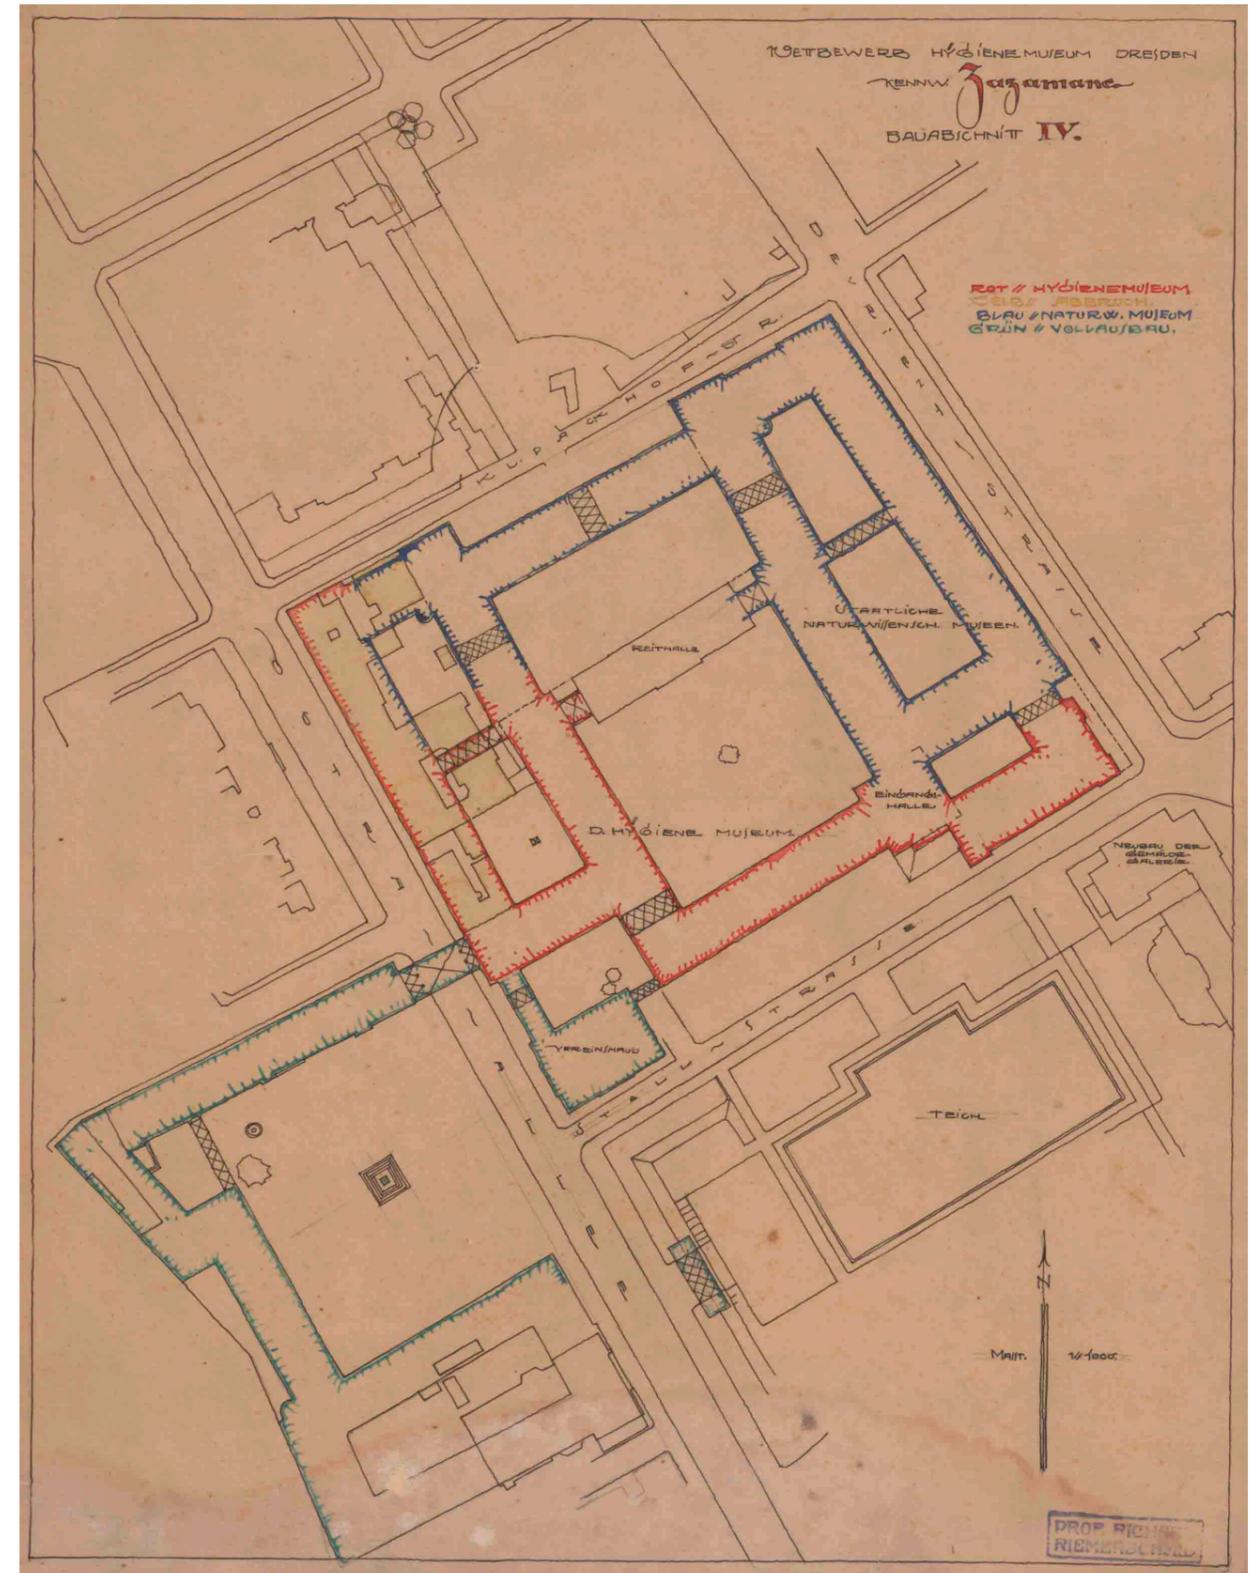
Bauabschnitt IV (Grundriss)
